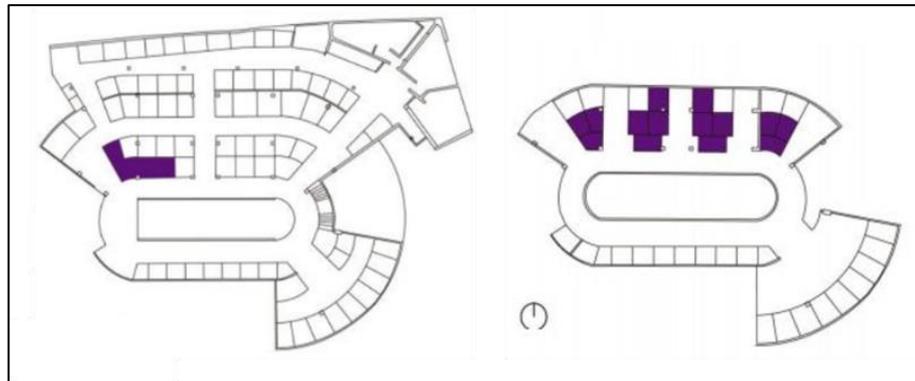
Planta esquemática del 2° Y 3° Nivel del mercado de Surquillo
